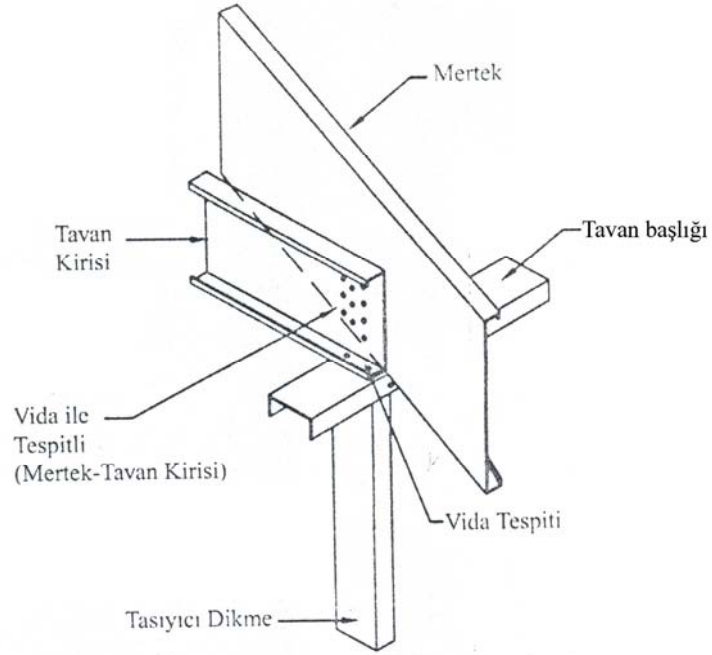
Dikme – döşeme kirişi ve merteklerin eksenlerinin çakışması
